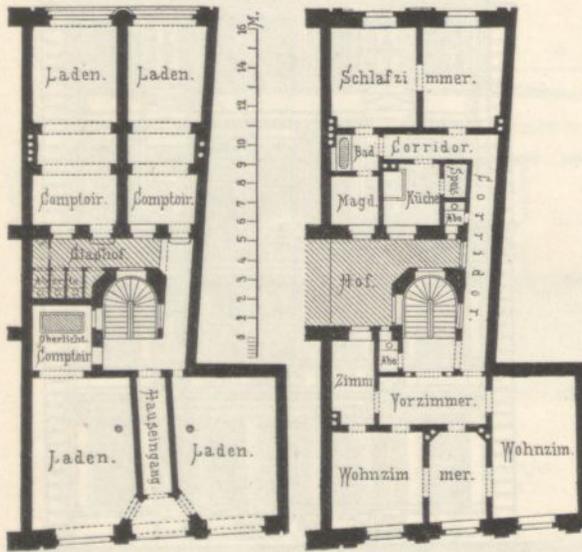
Erdgeschoss. Fig. 606. Obergeschosse.
